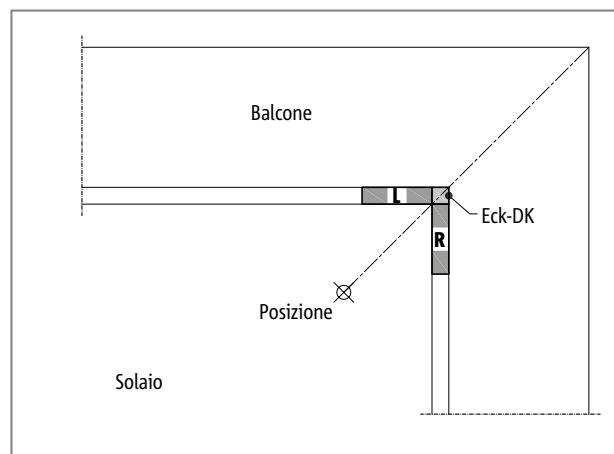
Schöck Isokorb® tipo EXT: disposizione EXT-L a sinistra della posizione; disposizione EXT-R a destra della posizione
